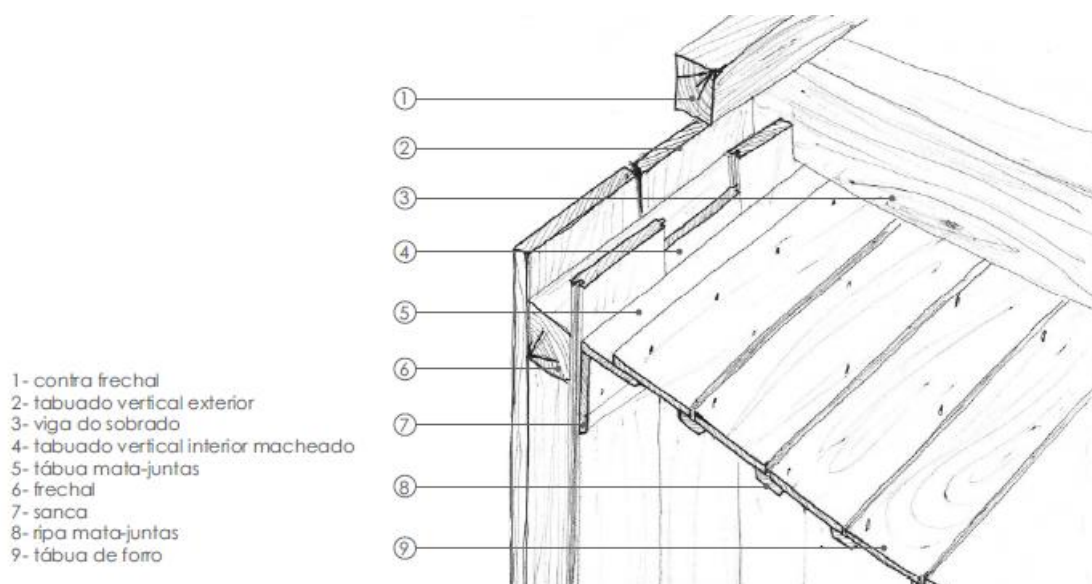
Pormenor tipo do revestimento interior das paredes exteriores (fonte: Moutinho (2007))
